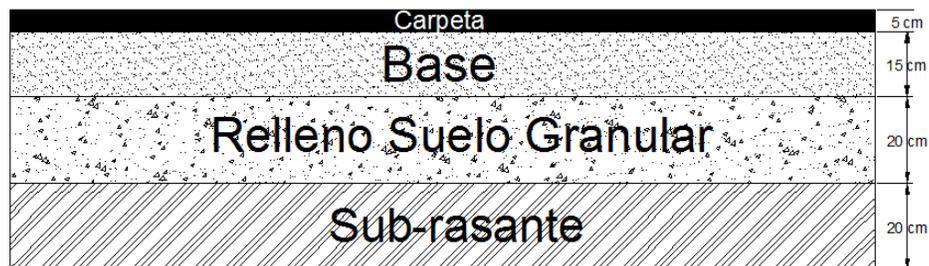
Estructura de Pavimento Flexible (Fuente Propia)
